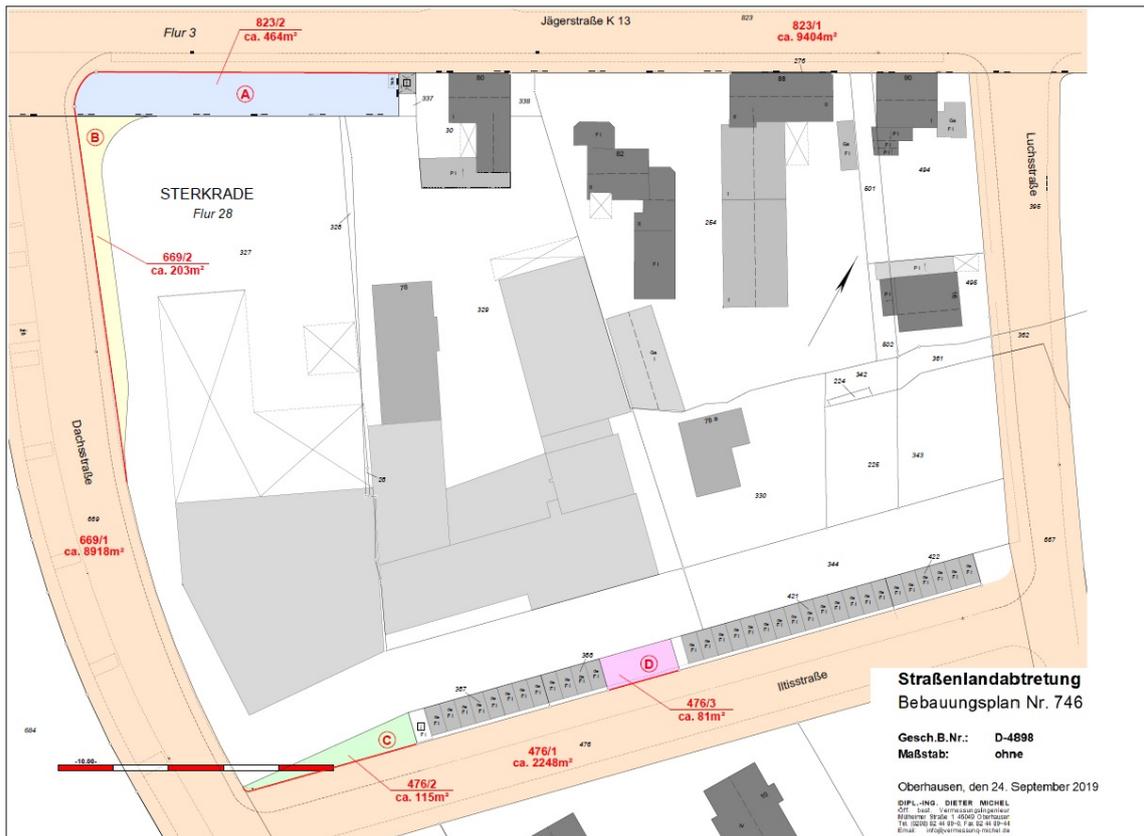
Grundstücksarrondierung, ÖBVI Michel, Stand 24.09.2019 © Stadt Oberhausen
